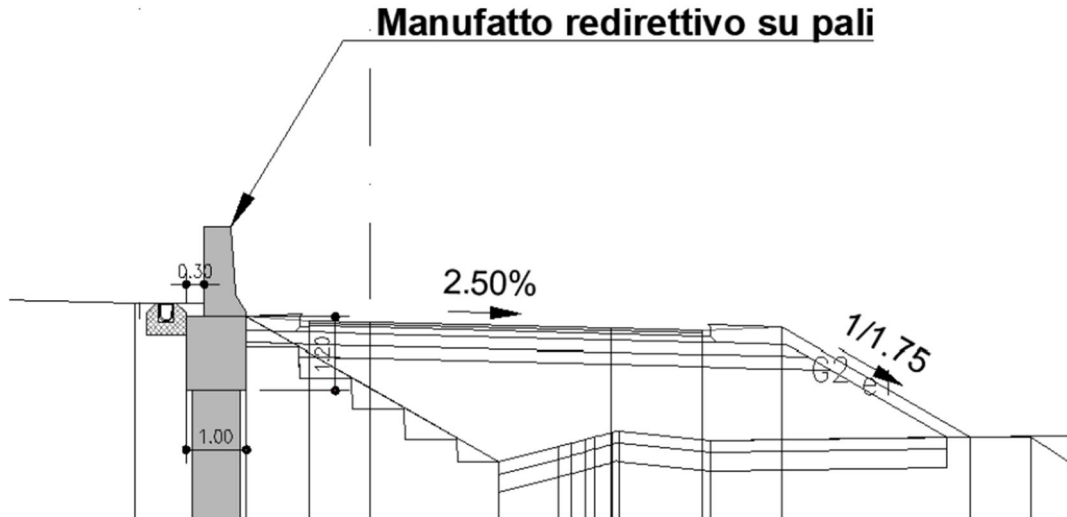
MS002 - MS007 - Sezione tipo manufatto redirettivo
